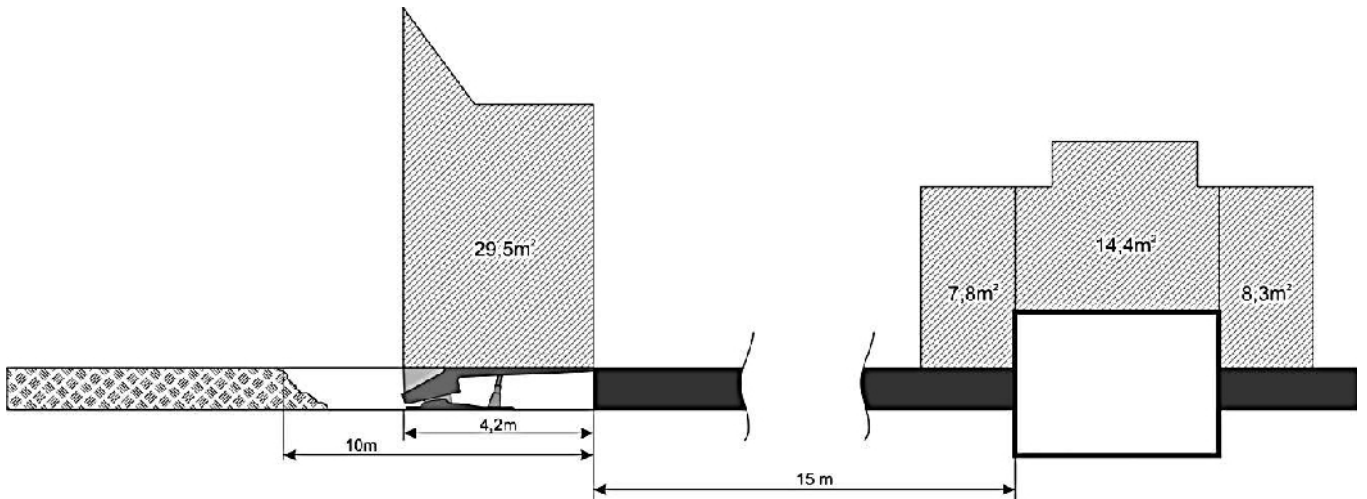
Площади зон разрушения в момент приближения лавы к демонтажной камере на расстояние 15 м (размер выработки 10 м)
